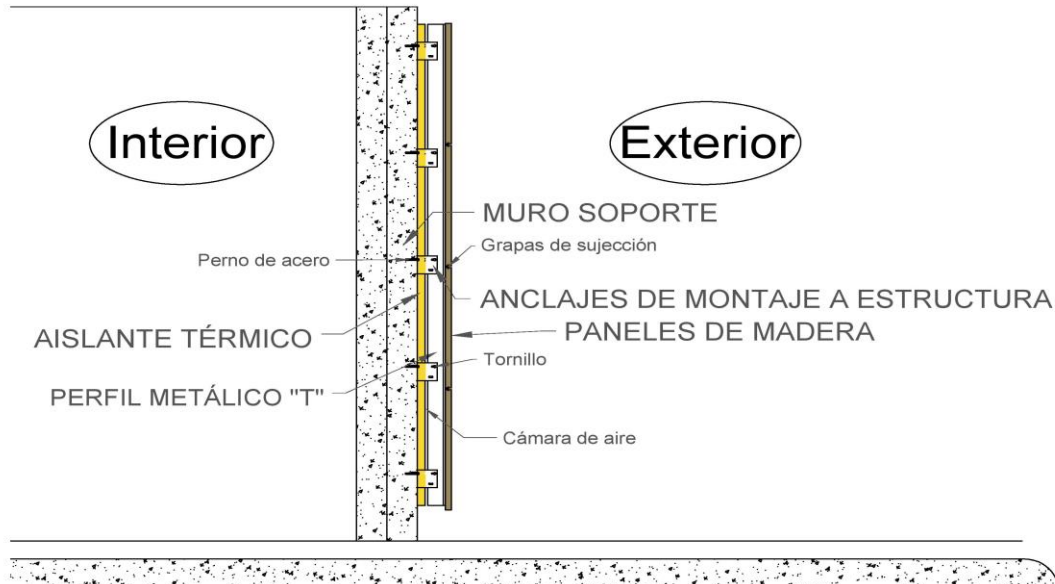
Detalle sistema constructivo fachada ventilada casa comunal
